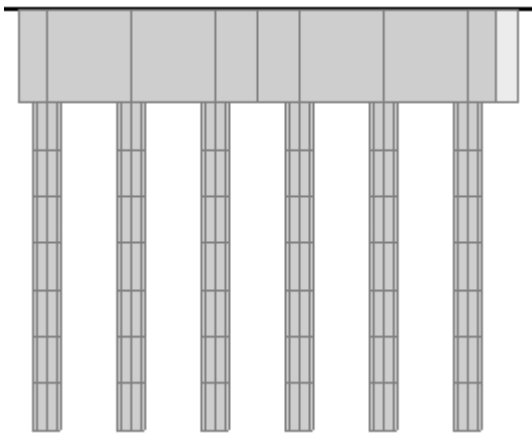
Modélisation des fondations (sens longitudinal)
